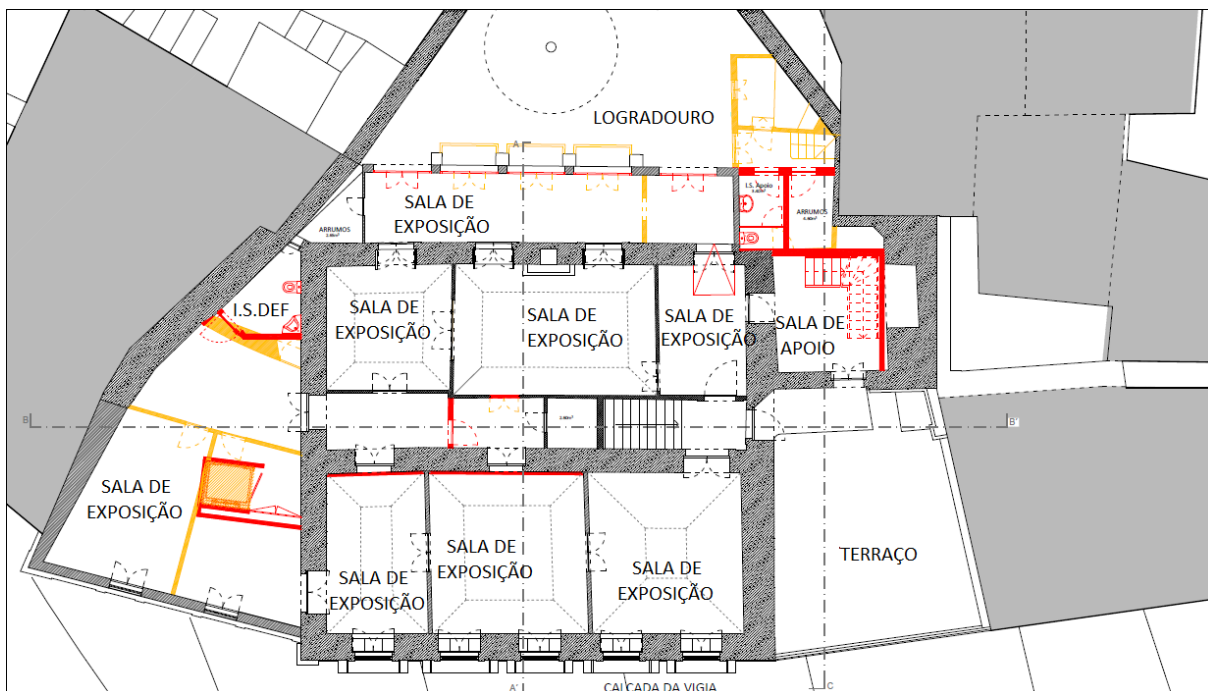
Planta do Piso 1 do edifício 1 em estudo
